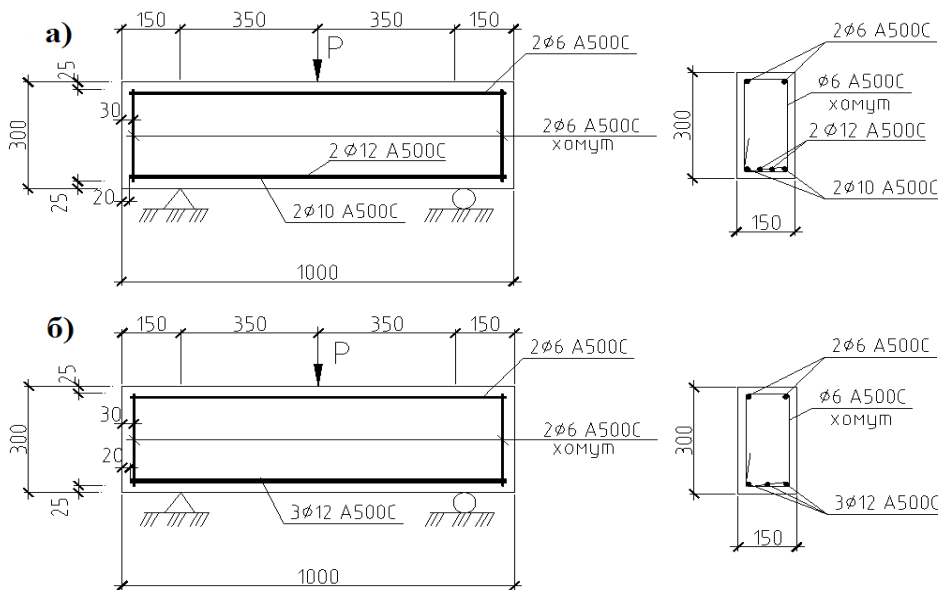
Конструкция, схемы армирования и схемы испытаний железобетонных балок-моделей из бетона В15 (а) и В25 (б) на действие поперечной силы (совместно с изгибающим моментом)
